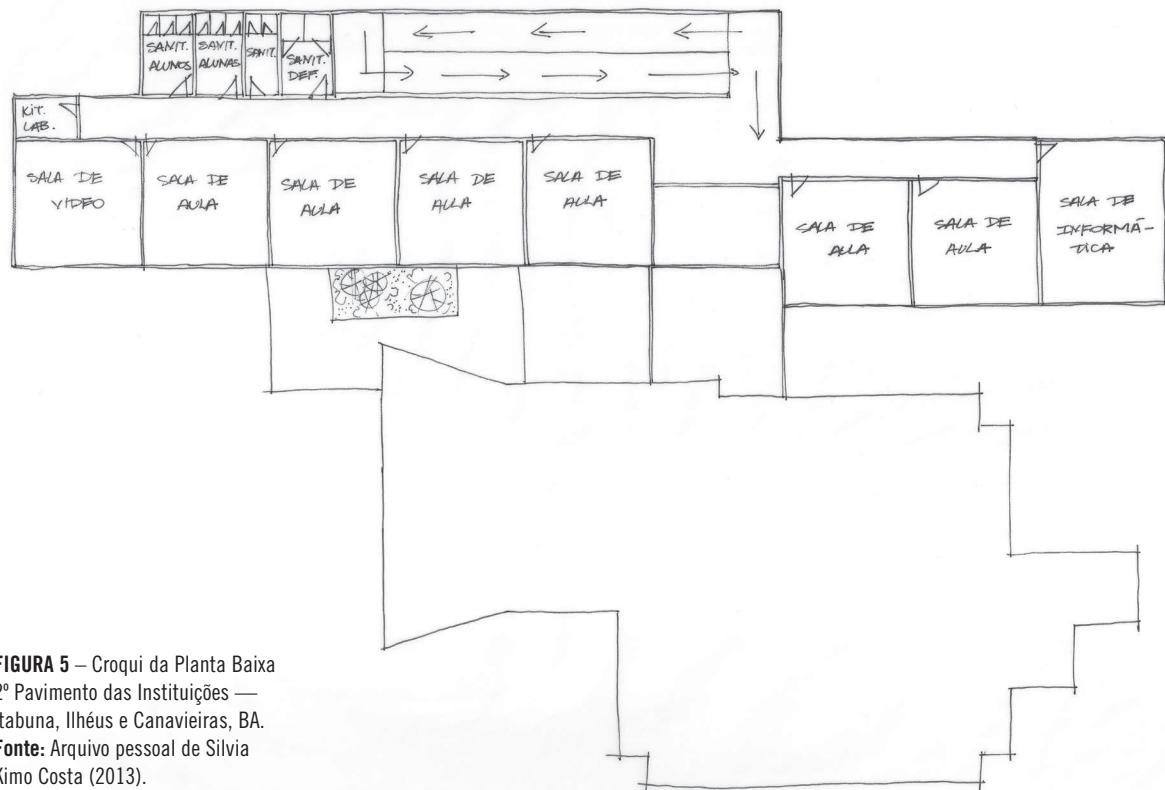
Croqui da Planta Baixa 2º Pavimento das Instituições — Itabuna, Ilhéus e Canavieiras, BA.
